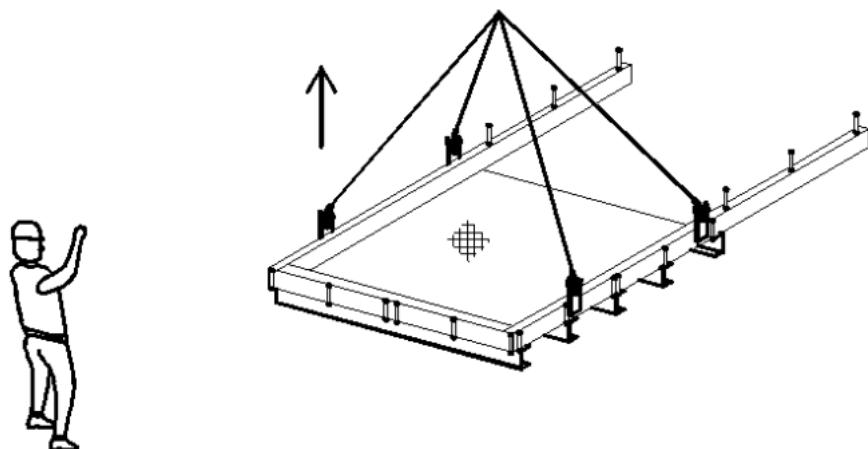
Подъем выносной площадки к месту ее установки
